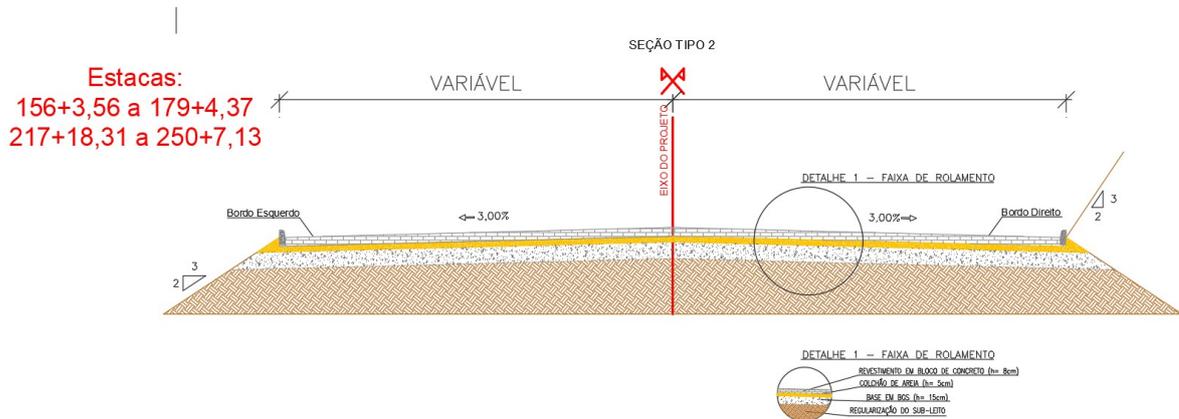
Seção geométrica do Trecho de pavimentação em blocos de concreto.
